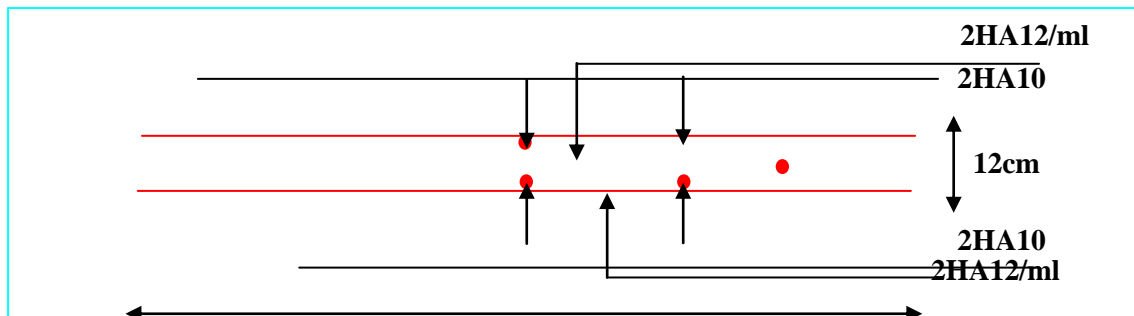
Schéma de ferrailage de la dalle pleine type N° 2.
